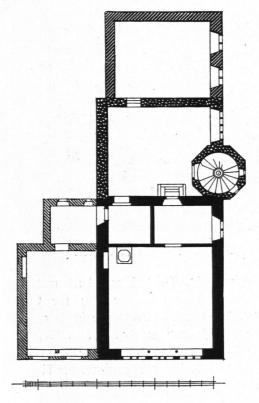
Rathaus zu Billingen. Grundriß bes erften Stocks.
